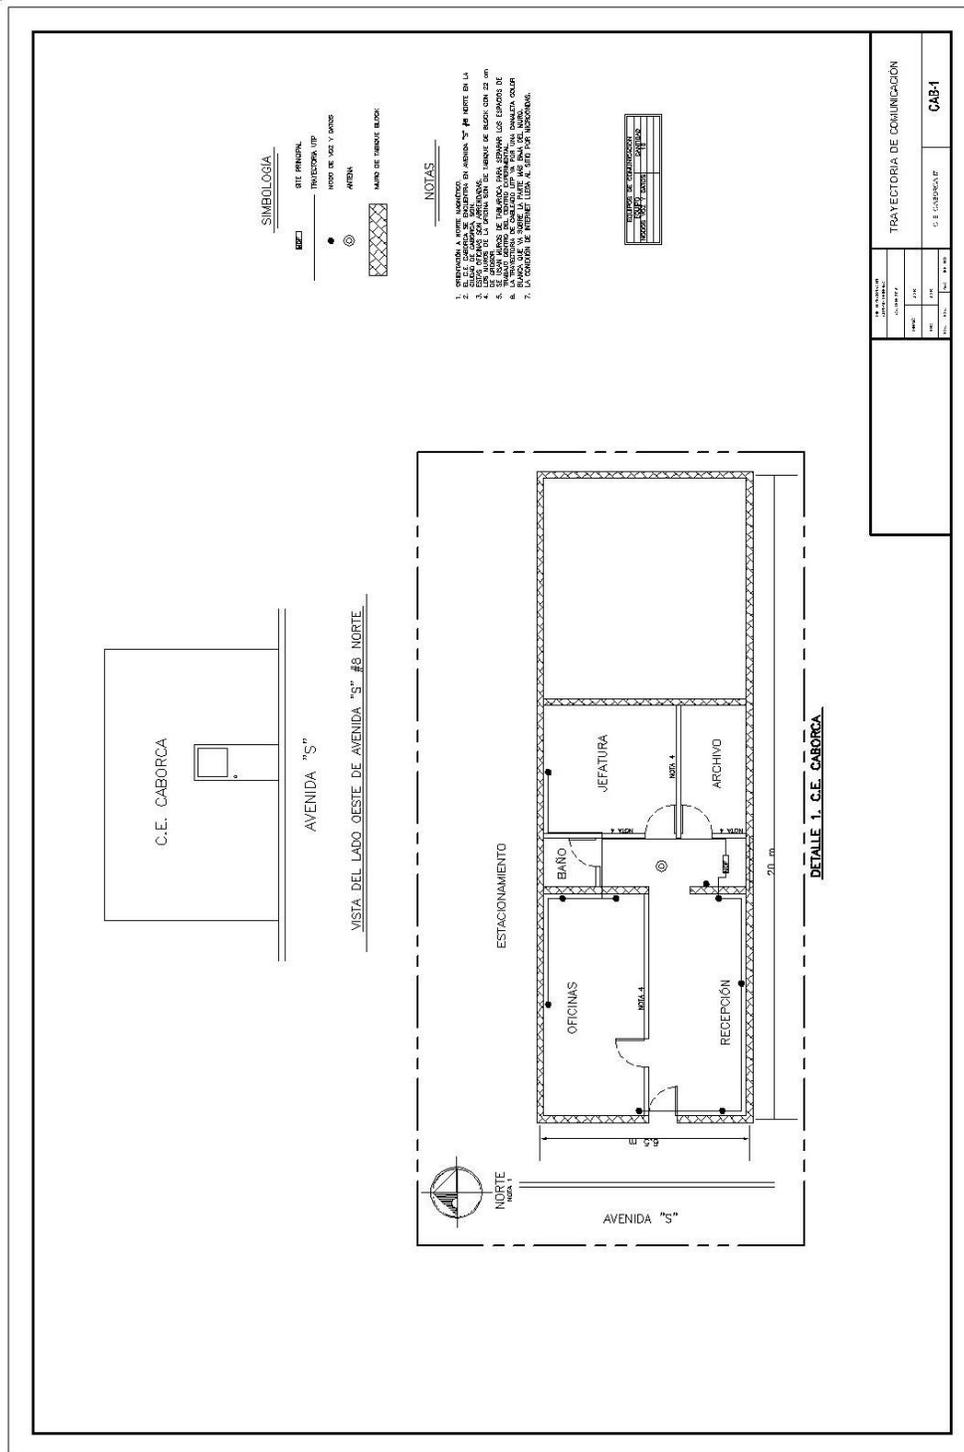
Plano de las oficinas de Caborca en Sonora (fuente: plano realizado por el autor).
